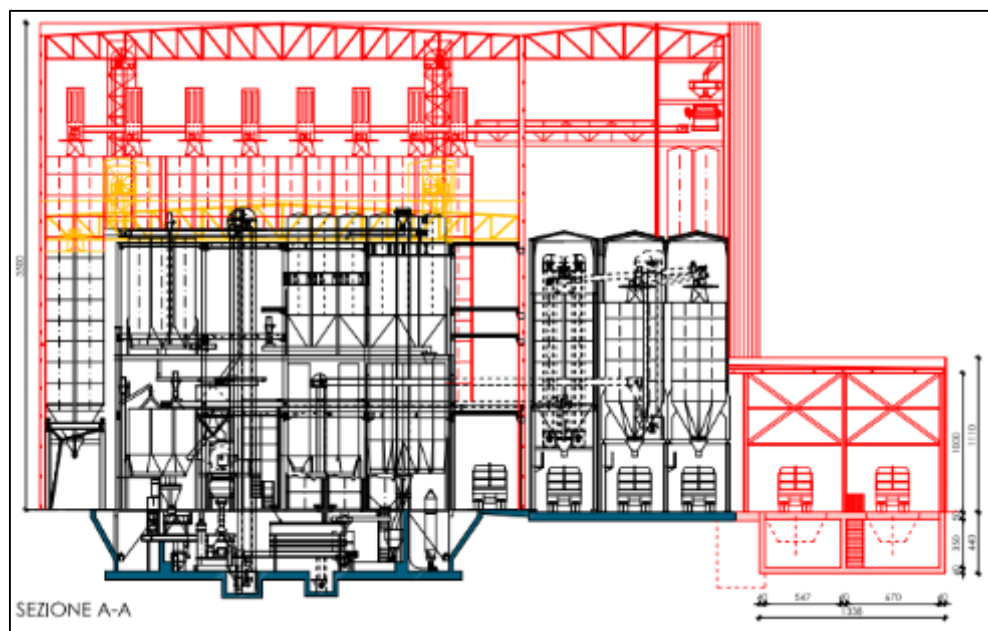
Sezione - sovrapposizione con stato di progetto
